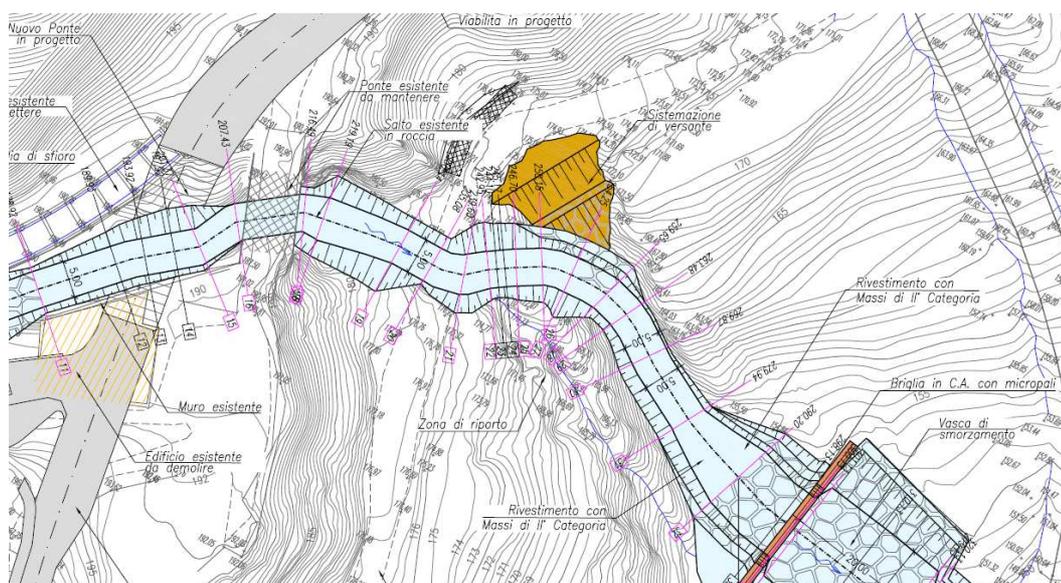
Planimetria Tavola 2/3 – Borro Pianale
